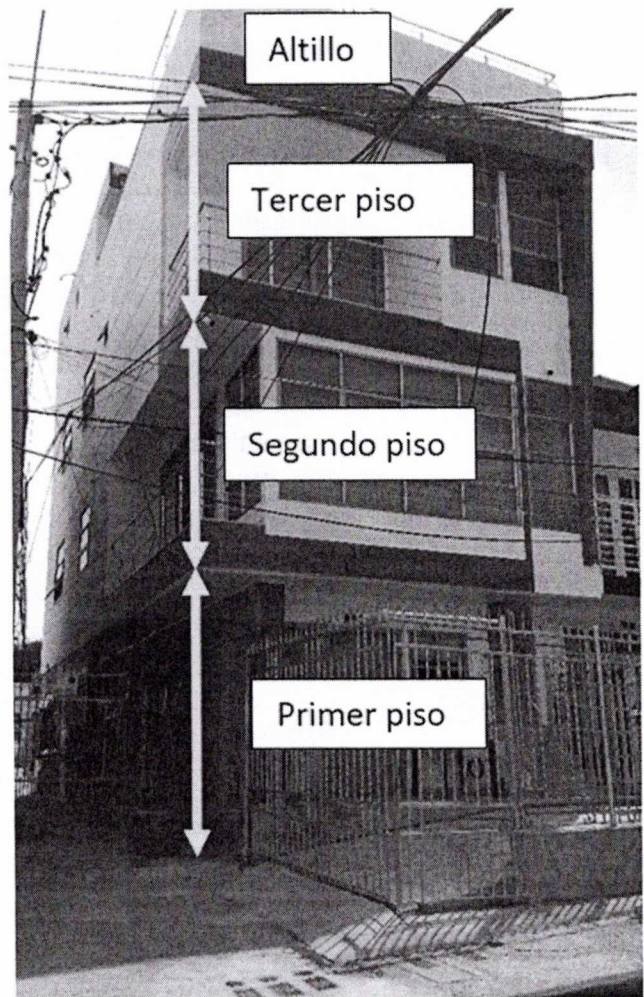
Fachada del predio existente. Fuente: Dirección de Control Urbano – DCU.
